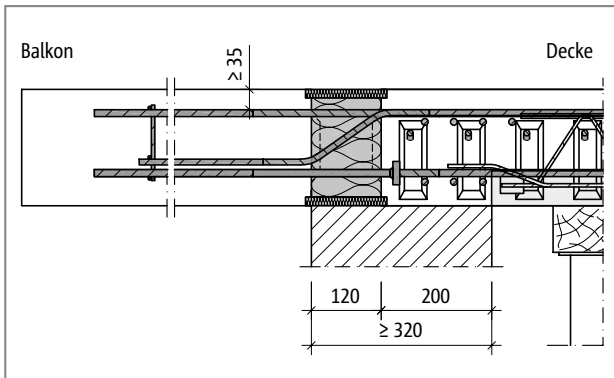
Schöck Isokorb® XT Typ C: Elementplatte mit Randunterstützung mit wärmedämmendem Mauerwerk (Schnitt XT Typ C-L-CV35, Ansicht XT Typ C-R-CV50)
